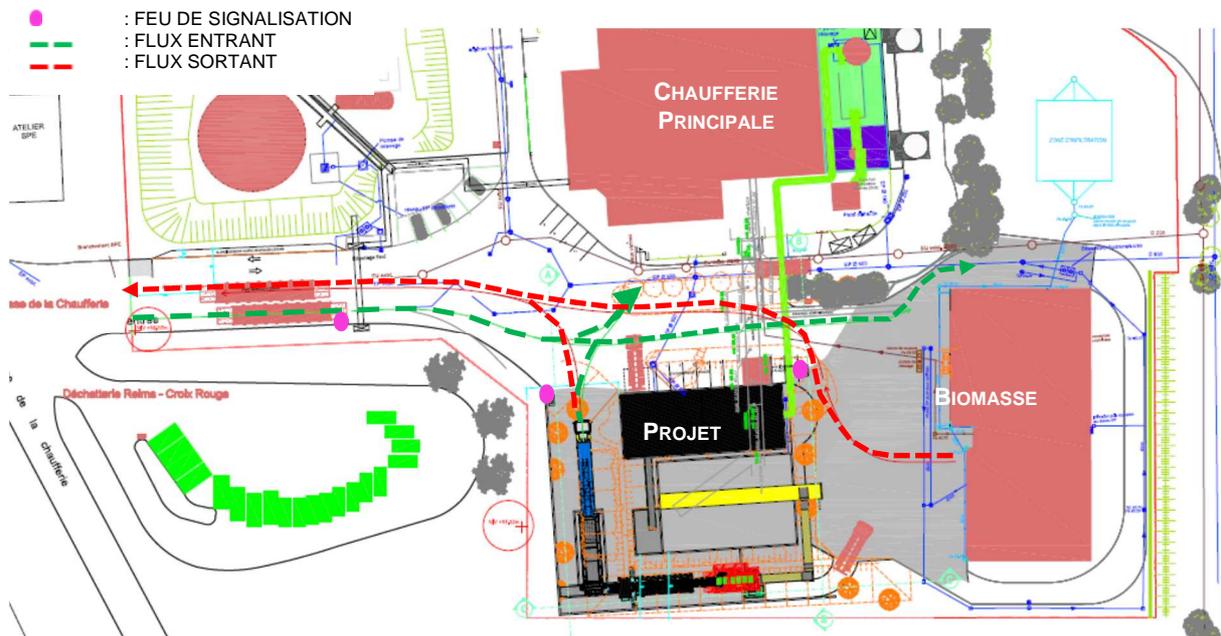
PLAN DE CIRCULATION INTERNE AU SITE – VARIANTE N°2
